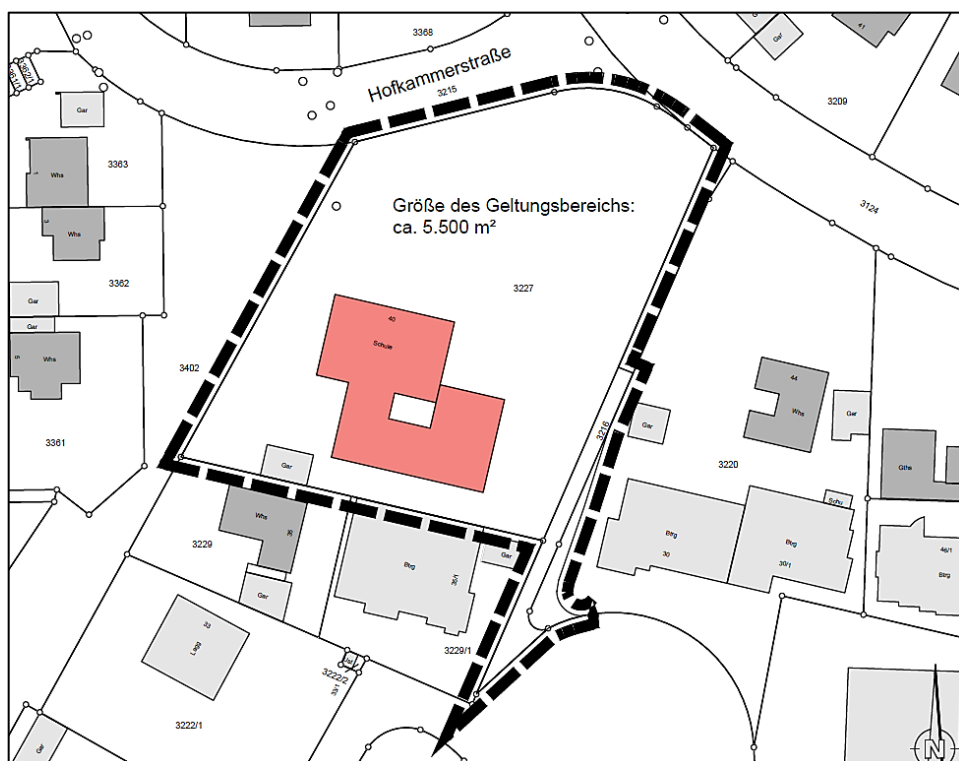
Lageplan des Gebiets mit räumlichem Geltungsbereich, o.M.
